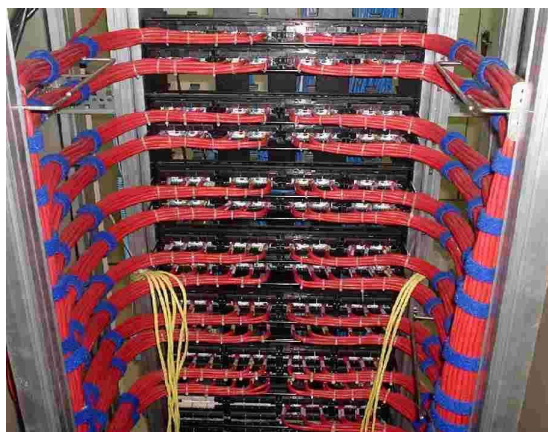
Exemplo de cabeamento estruturado sobre *Patch Panel* realizado por empresa prestadora de serviços de Infraestrutura de TI
